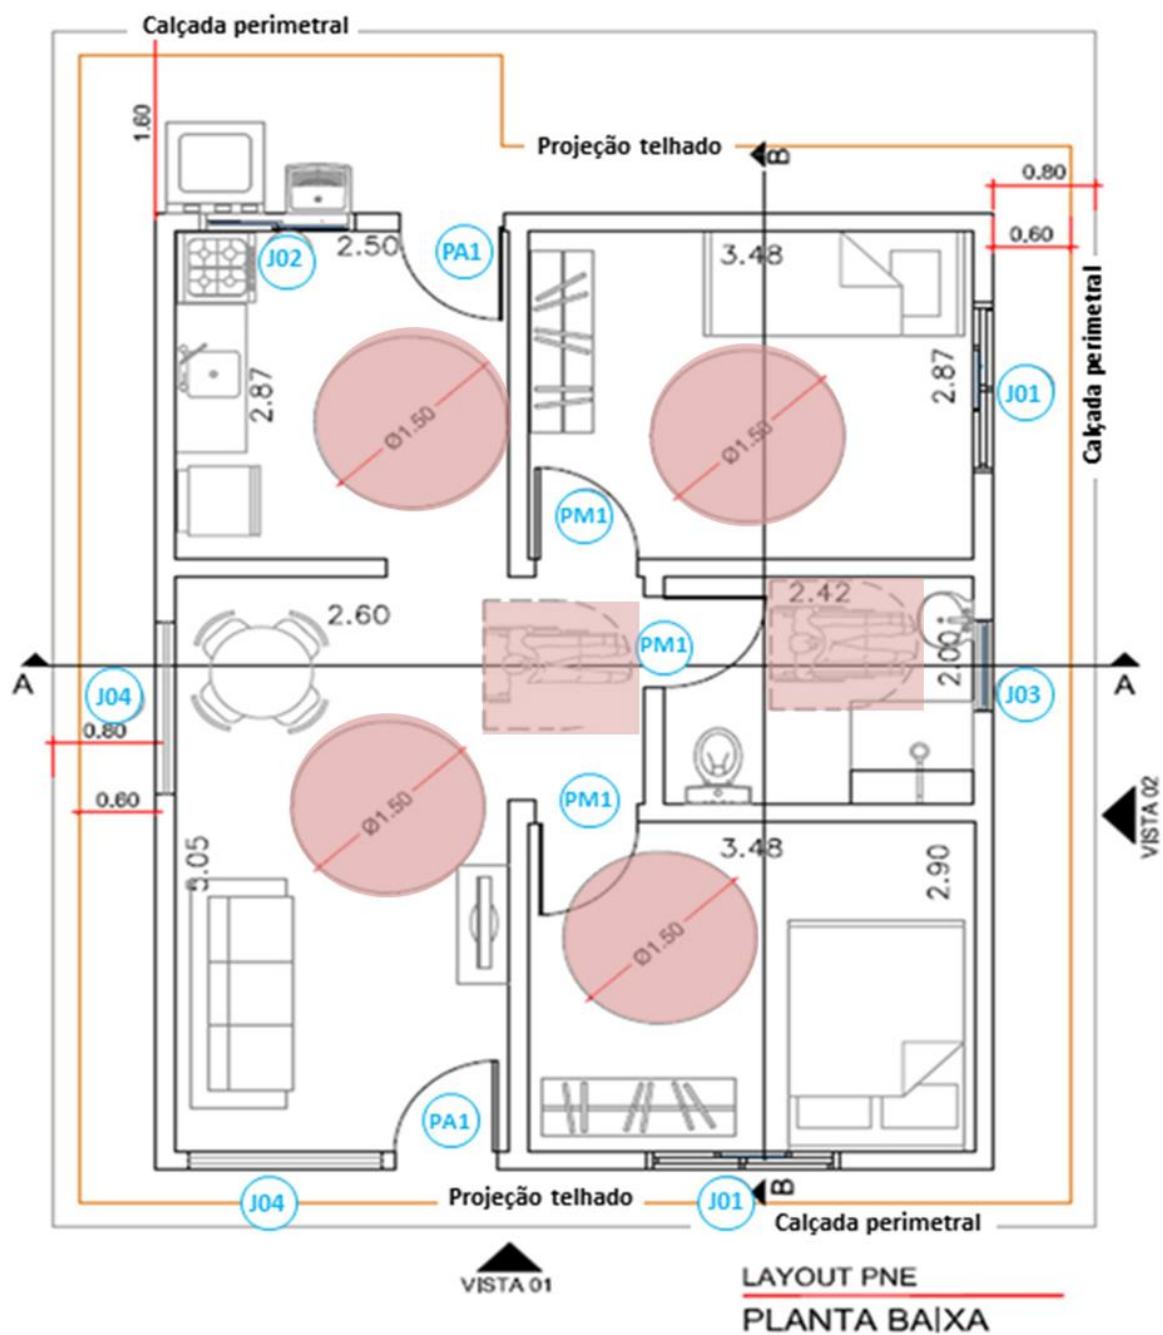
Planta modelo da unidade de São Miguel Arcanjo (sem escala) com layout para PNE: módulo de rotação de 360° e manobra de 180°.
